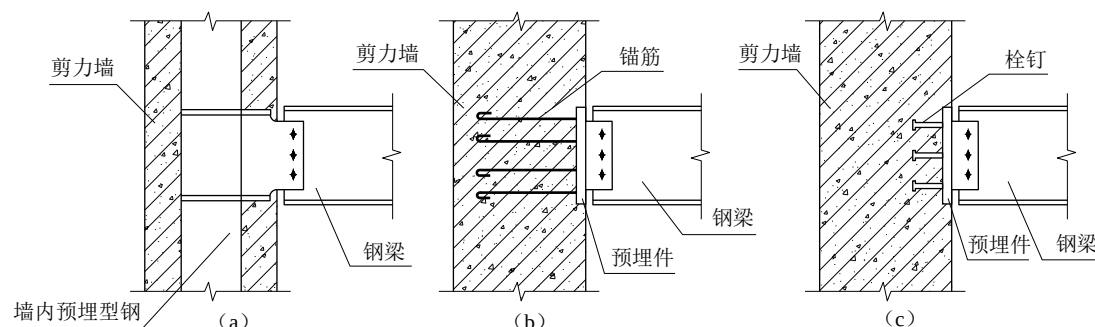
钢梁与混凝土墙的铰接连接示意图
